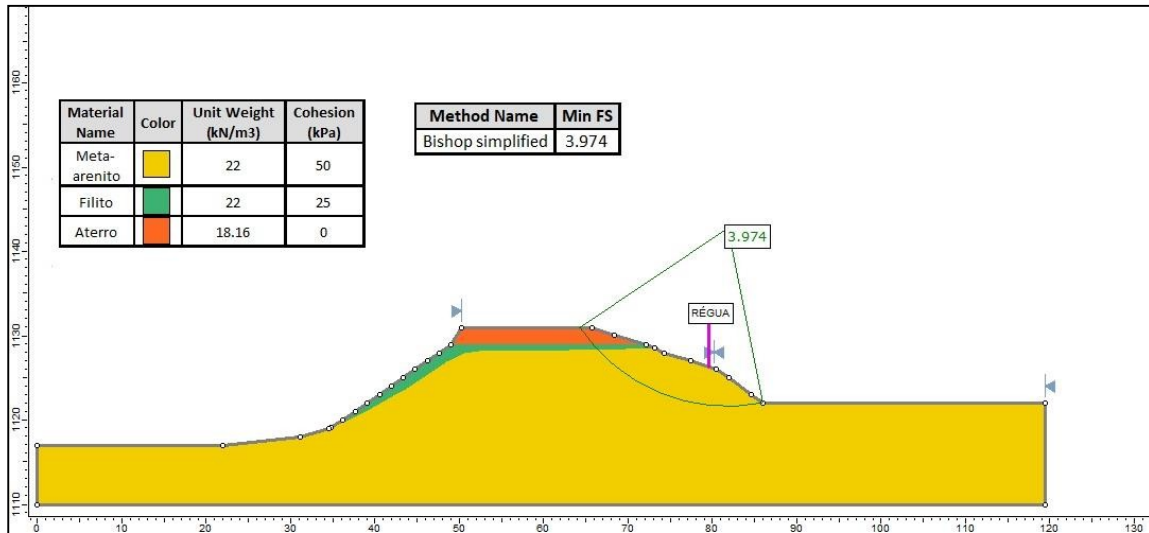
Fase final de construção – Bishop Simplificado – Montante – Global.
